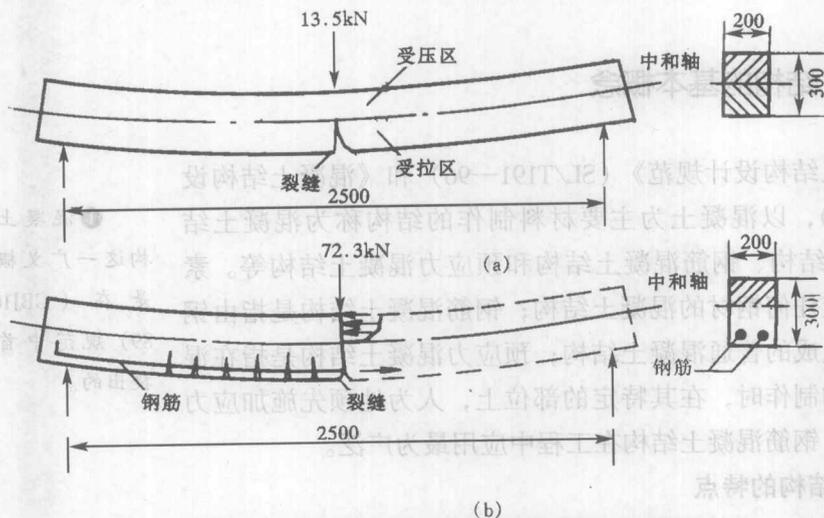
素混凝土与钢筋混凝土筒支梁的破坏情况对比
